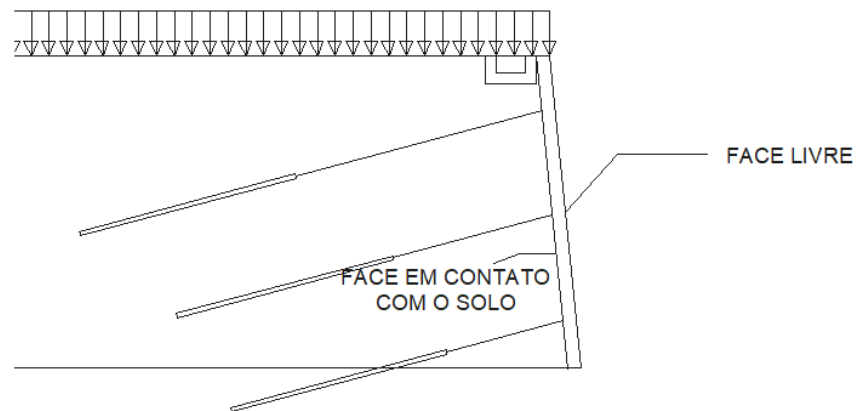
Faces da laje de concreto armado onde serão distribuídas as armaduras no talude de areia.
